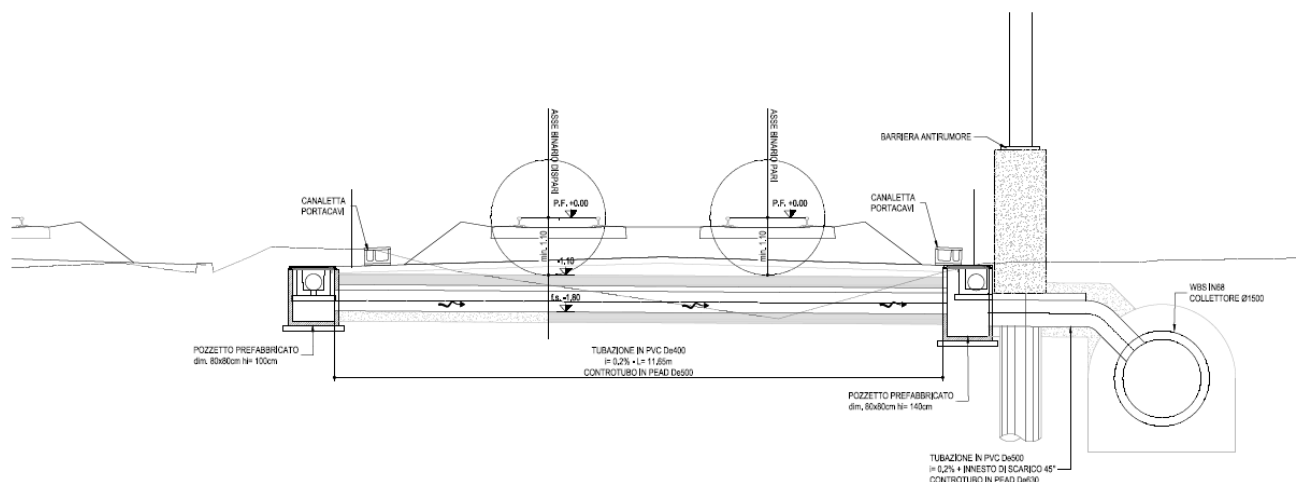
Sezione del rilevato RI82 con scarico nello scolo Altavilla
